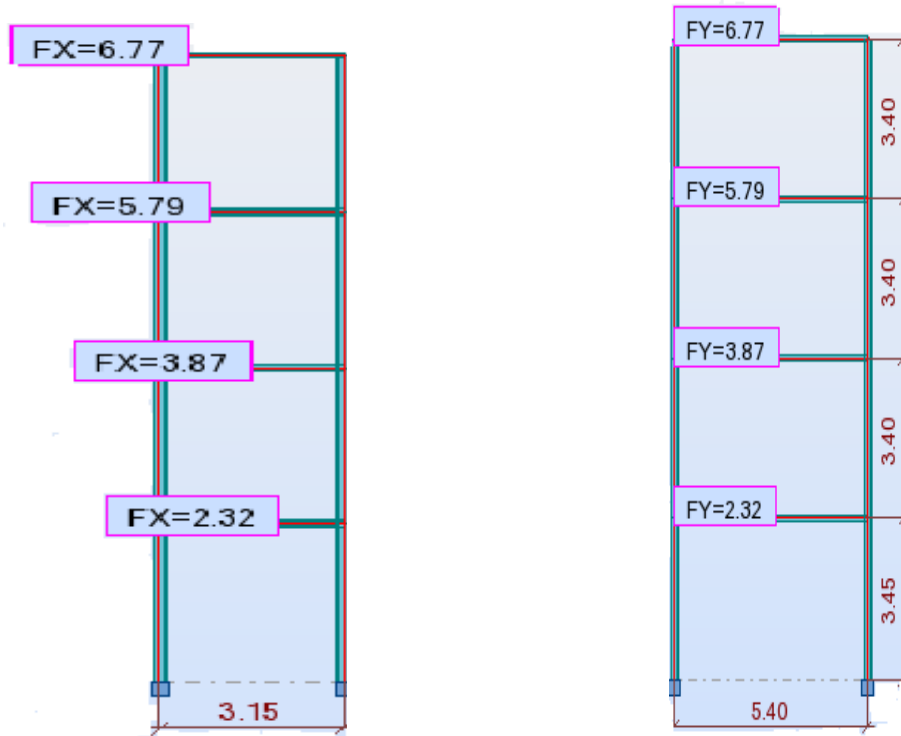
les forces reprisent par portique auto stable dans le sens longitudinal et transversale
